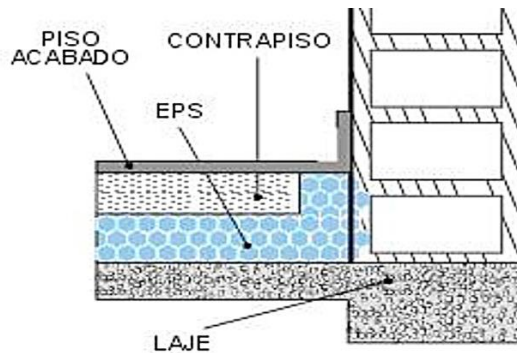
Esquema de pavimento flutuante (adaptado de [46])
